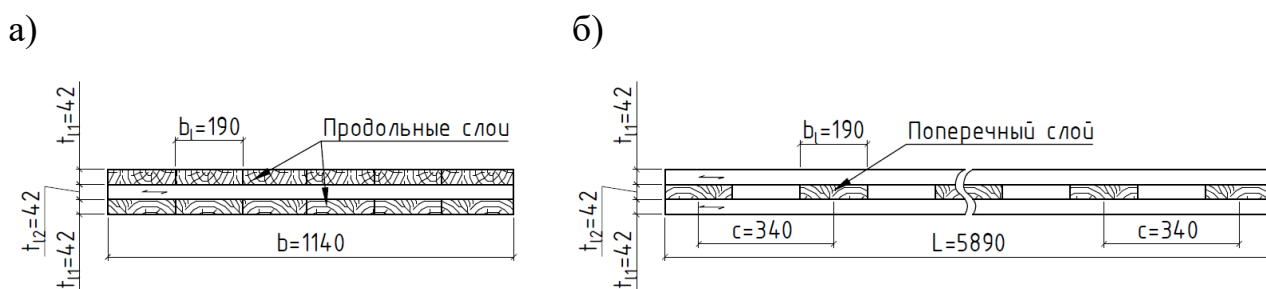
Трехслойная плита перекрытия из ДПК с шагом в поперечном слое $c=340$ мм
